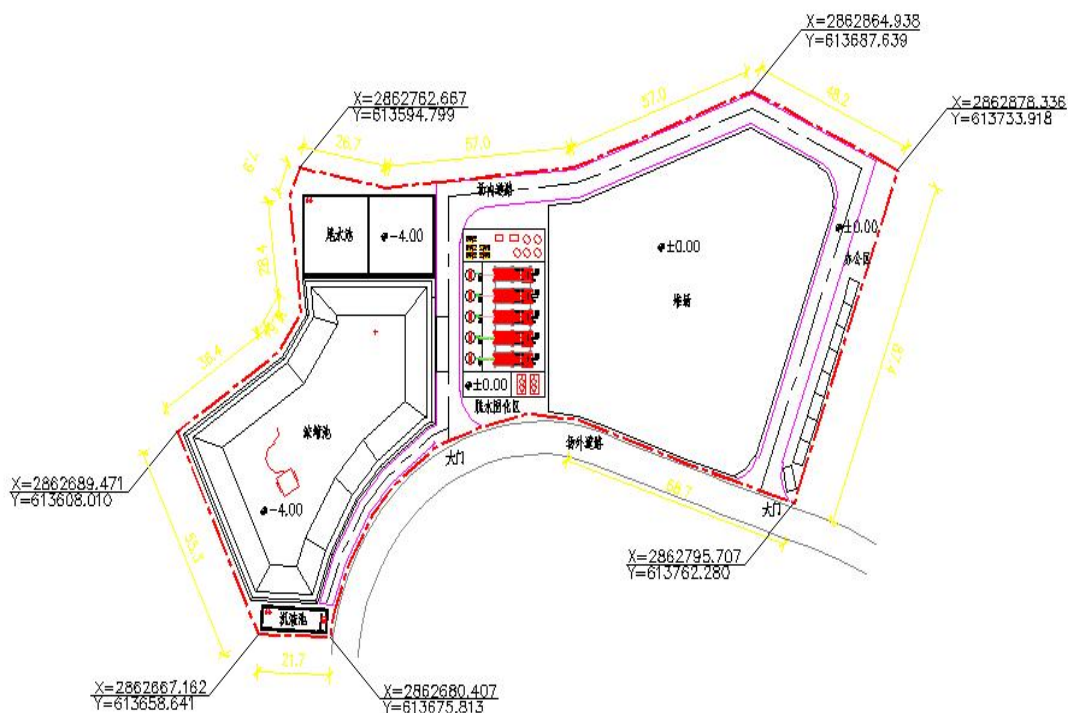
喜洲镇深江村淤泥固化场平面布置图
